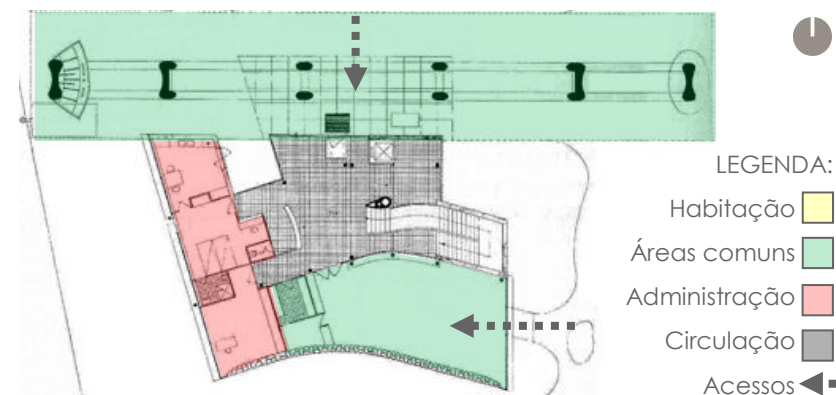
Planta pavimento térreo | Fonte: archigraphie.eu
